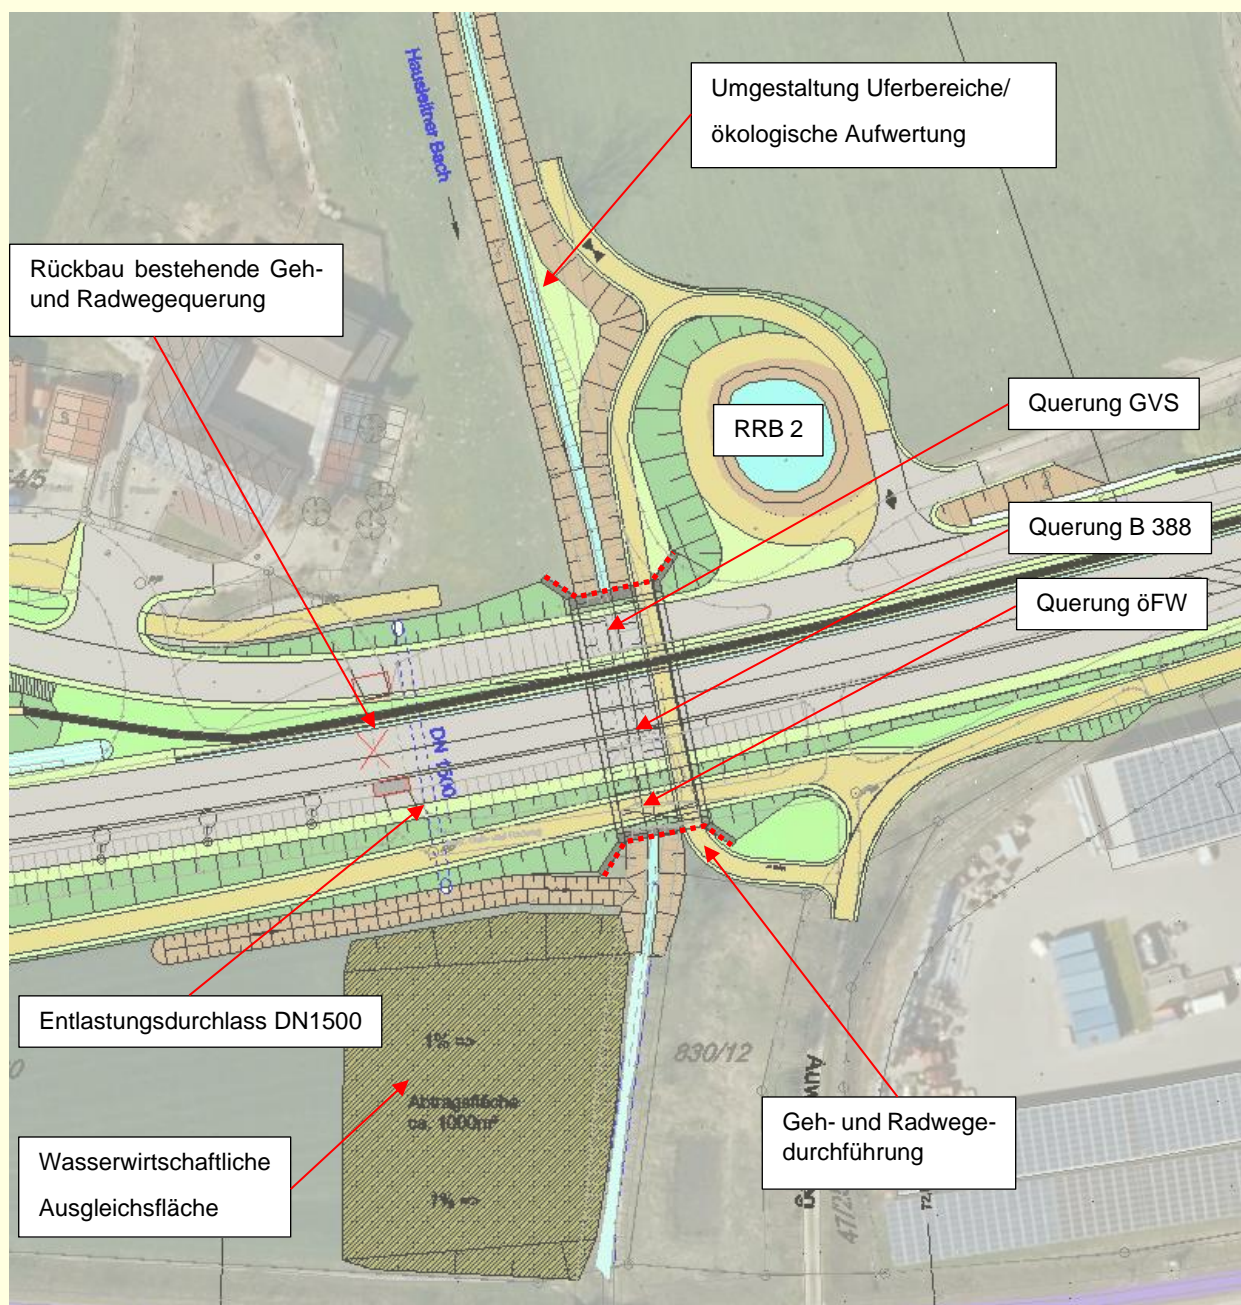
Lageplanauszug Detail. Planung mit einem Rahmenbauwerk und gewässerbegleitenden Maßnahmen über den Hausleitner Bach. Planstand September 2024
